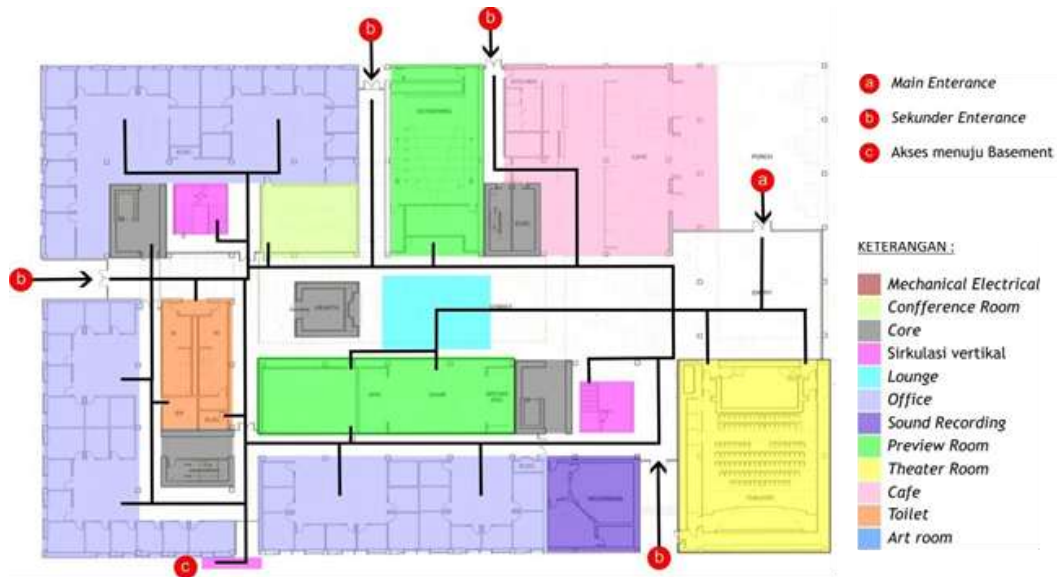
27 Detail Penzoningan Denah Lantai 3
